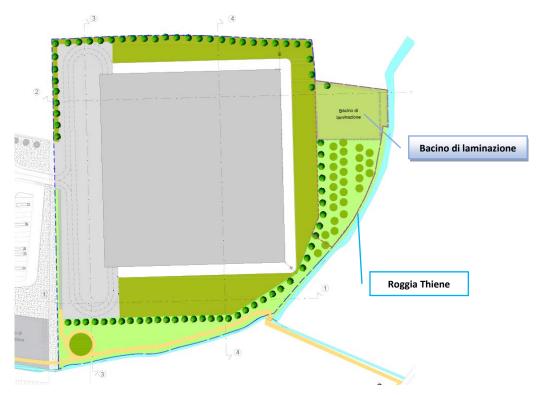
Planimetria stato di progetto con individuazione del bacino di laminazione e del corpo idrico ricettore
